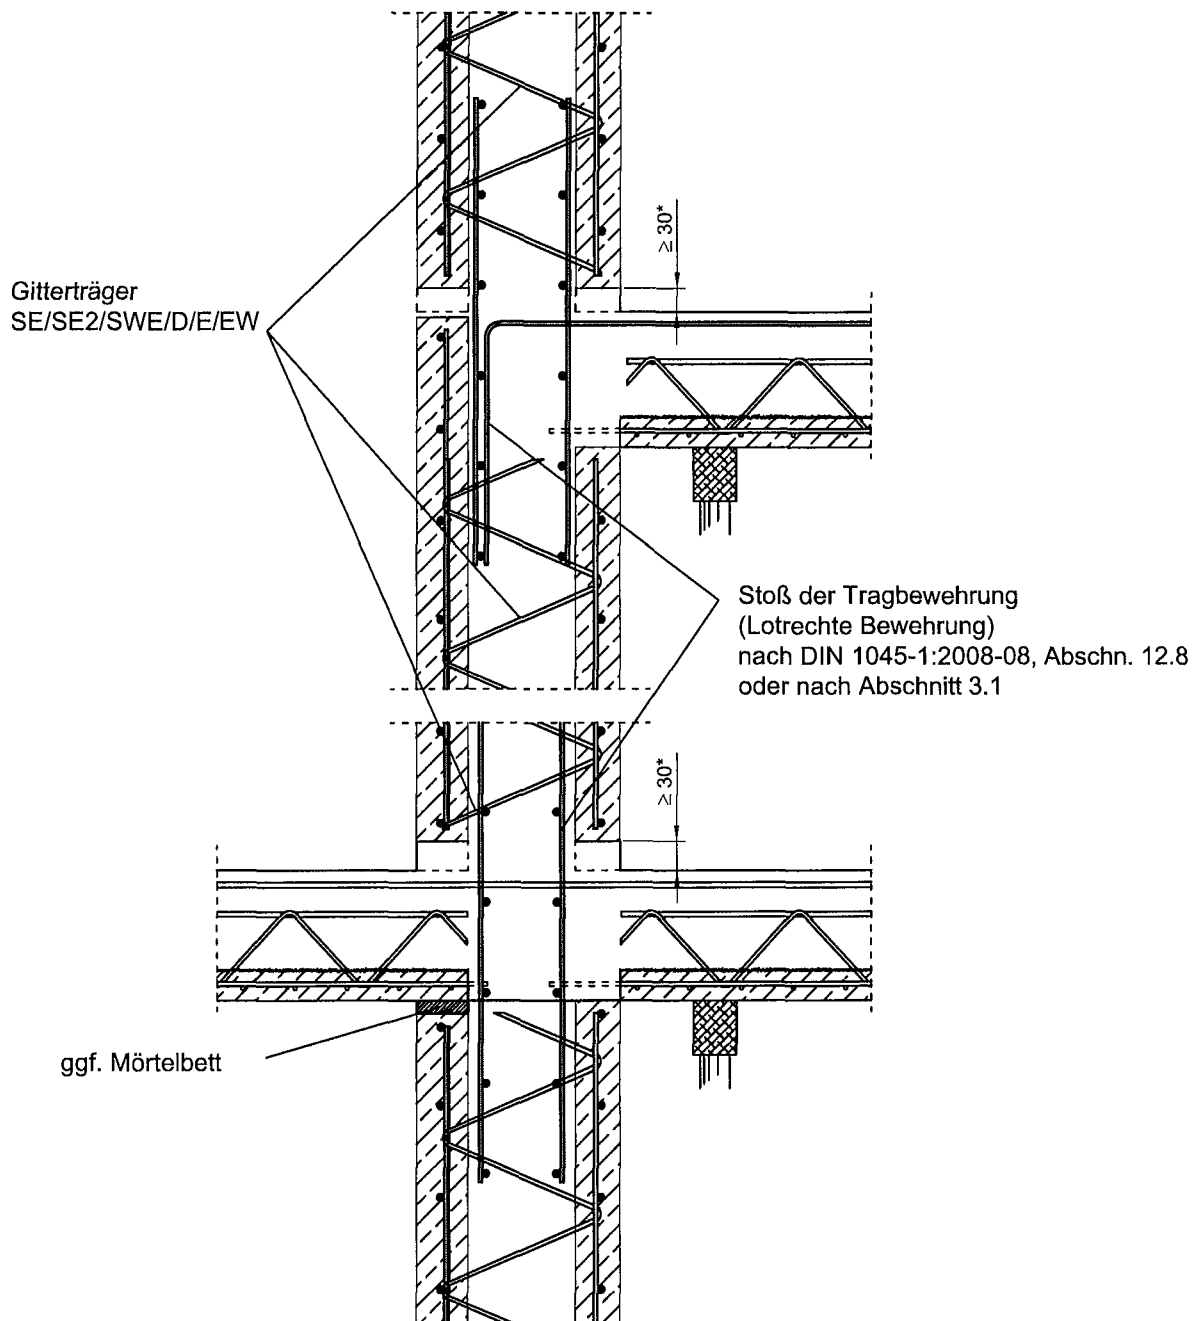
Außen- und Innenwandanschluss bei bewehrten Wänden
